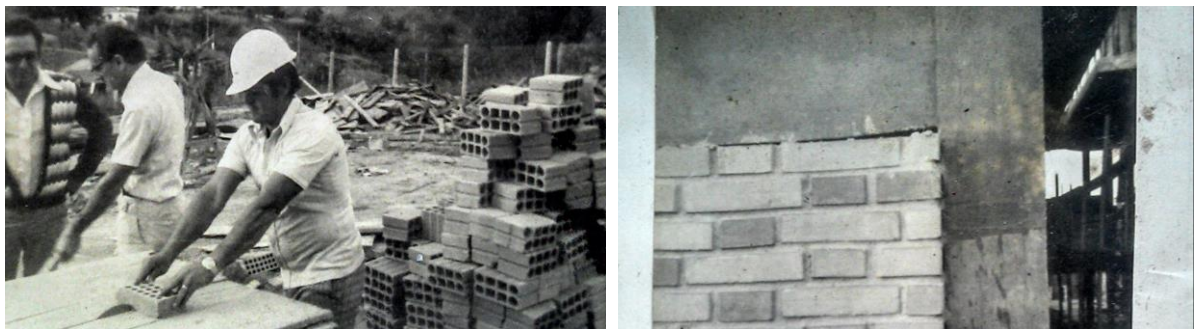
(a e b) – Edifício Anexo à antiga de Secretaria de Educação, projetado e construído pela CARPE (FONTE: IEPHA, 2004)
